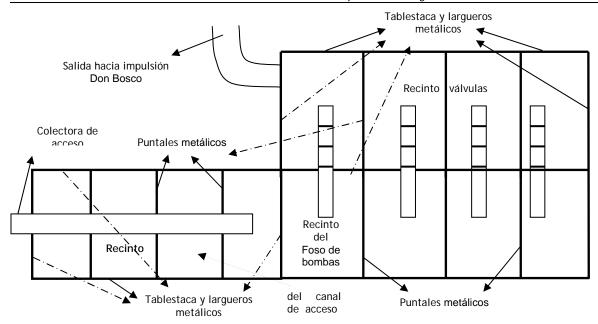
Vista en Planta de la Zona que debe llevar Tablestacas para Realizar las Excavaciones - Estación de Bombeo Tocumen
